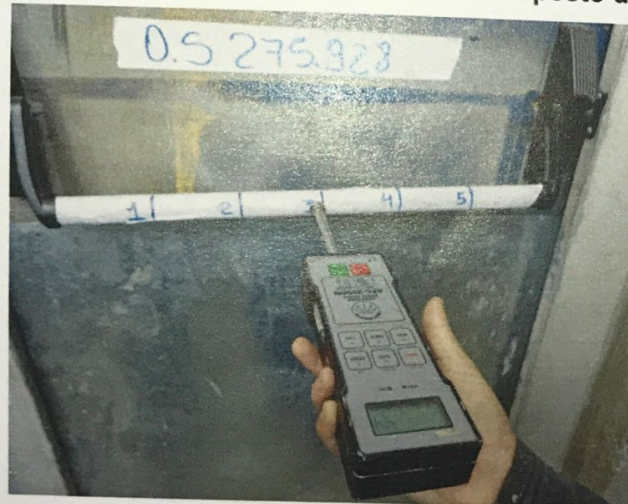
Ensaio de funcionamento – Centro da barra
